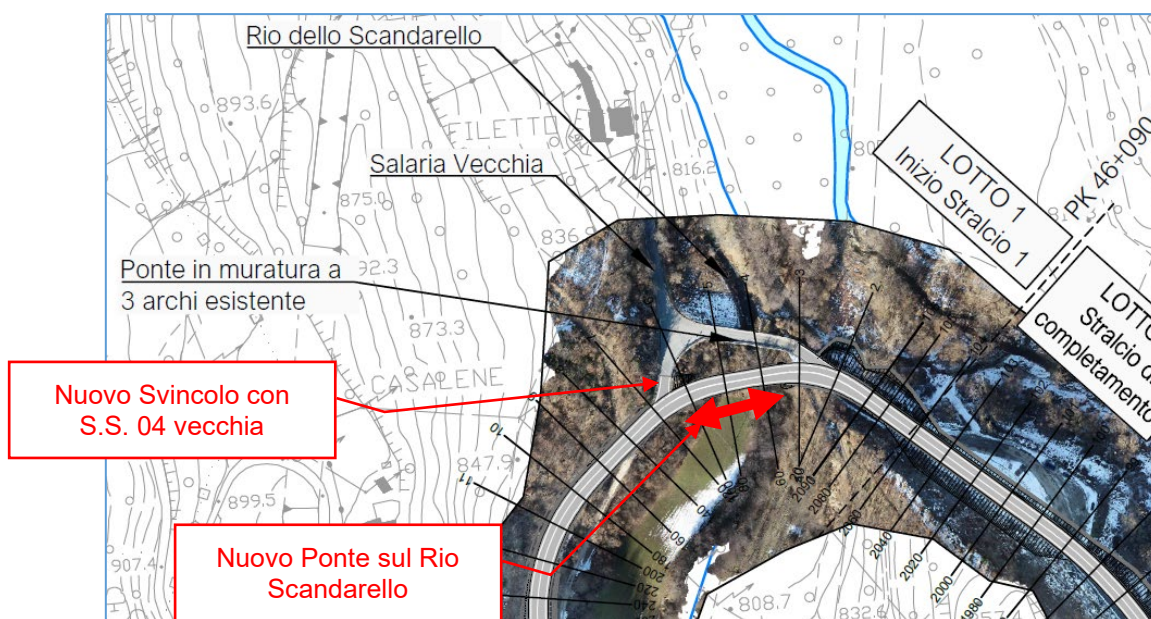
Ponte sul Rio Scandarello – Stralcio planimetrico
